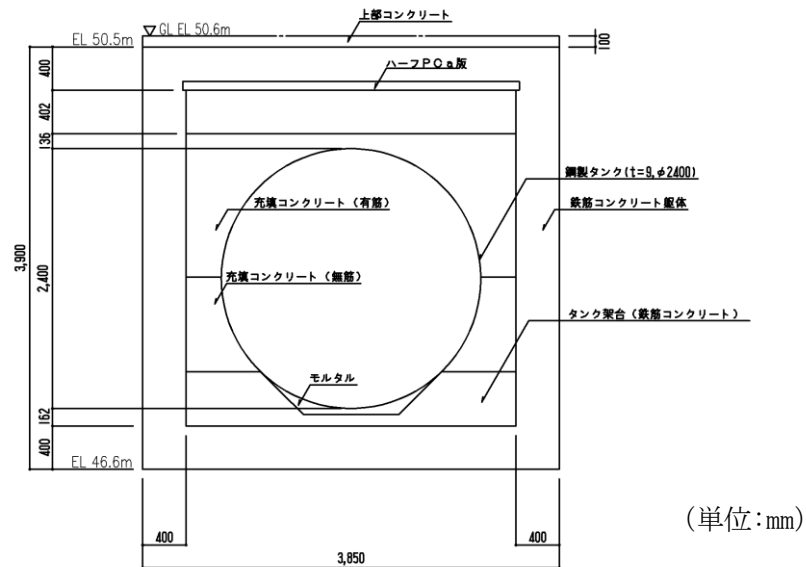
緊急時対策所用燃料地下タンク 断面図 (A-A断面)
